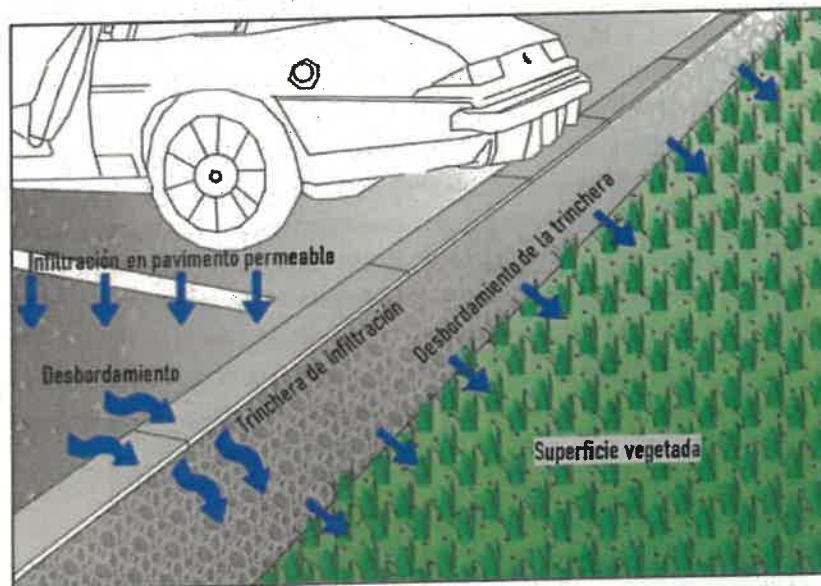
Trinchera de infiltración para flujo excedente de pavimento permeable.
